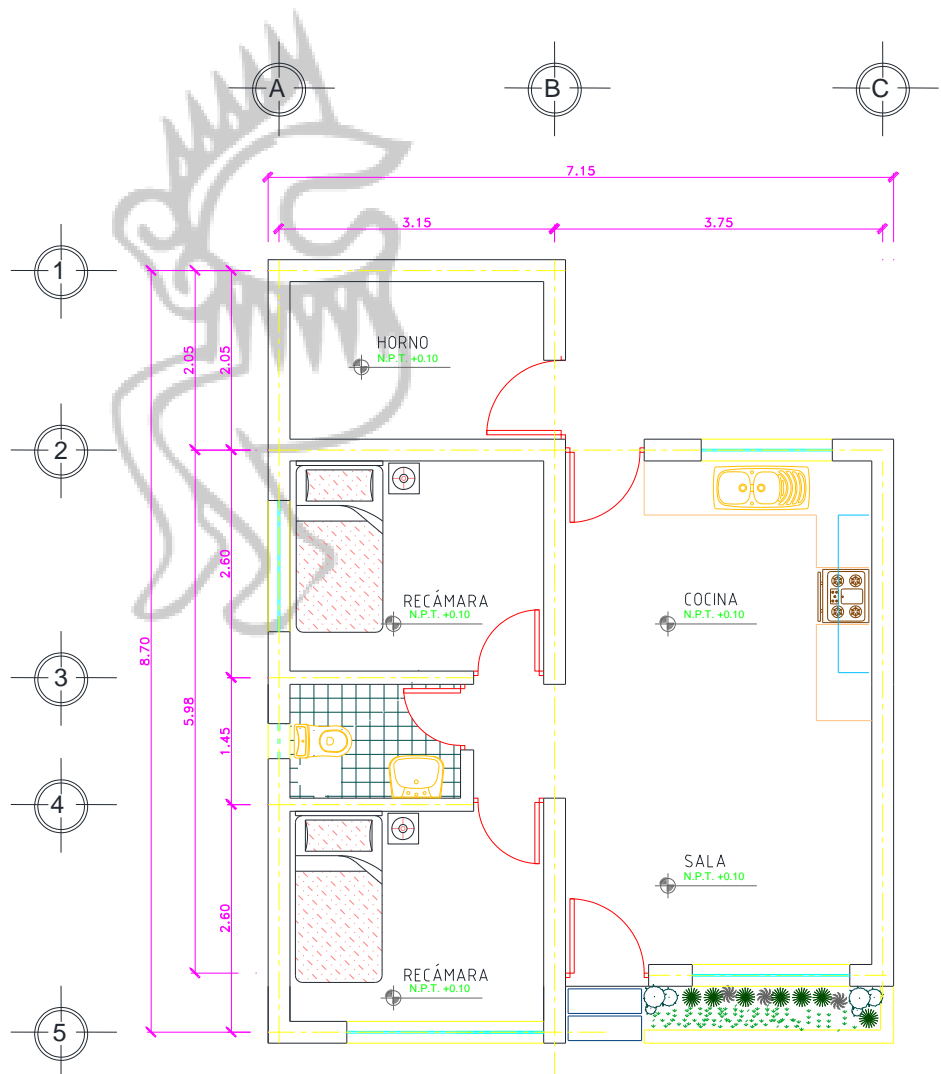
Planta de la vivienda rural. Elaboración propia (Septiembre, 2020)
